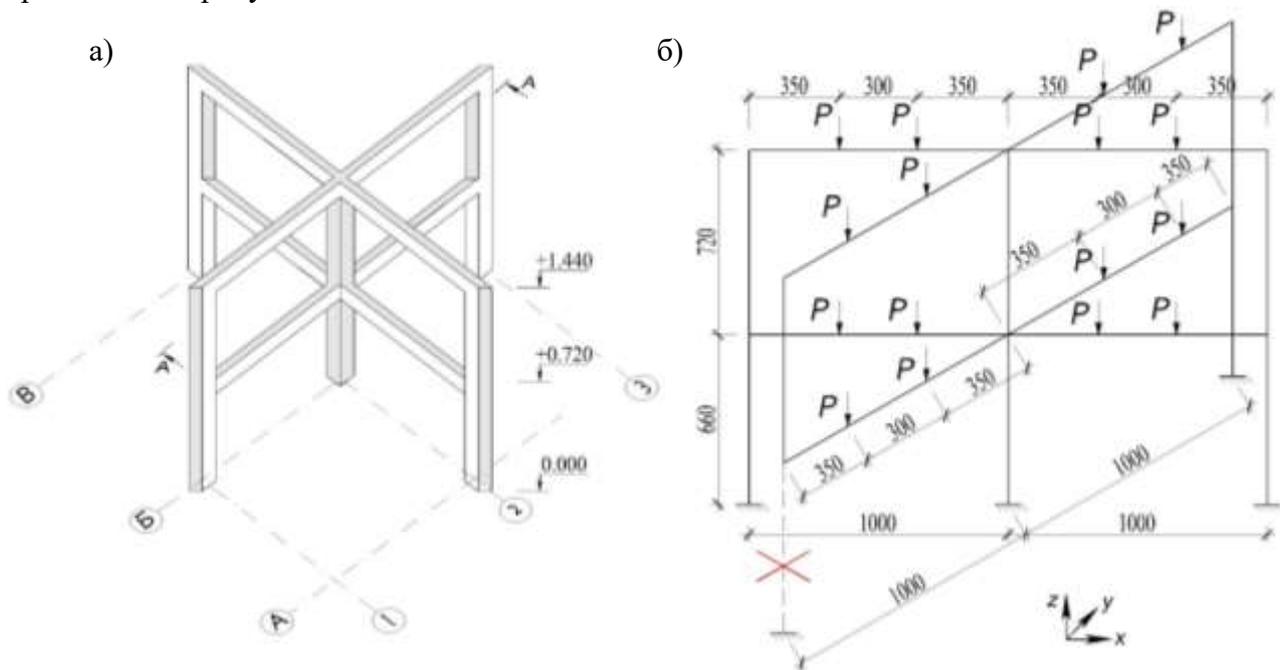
Общий вид пространственной железобетонной монолитной рамы (а); расчетная схема пространственной железобетонной монолитной рамной конструкции (б)
